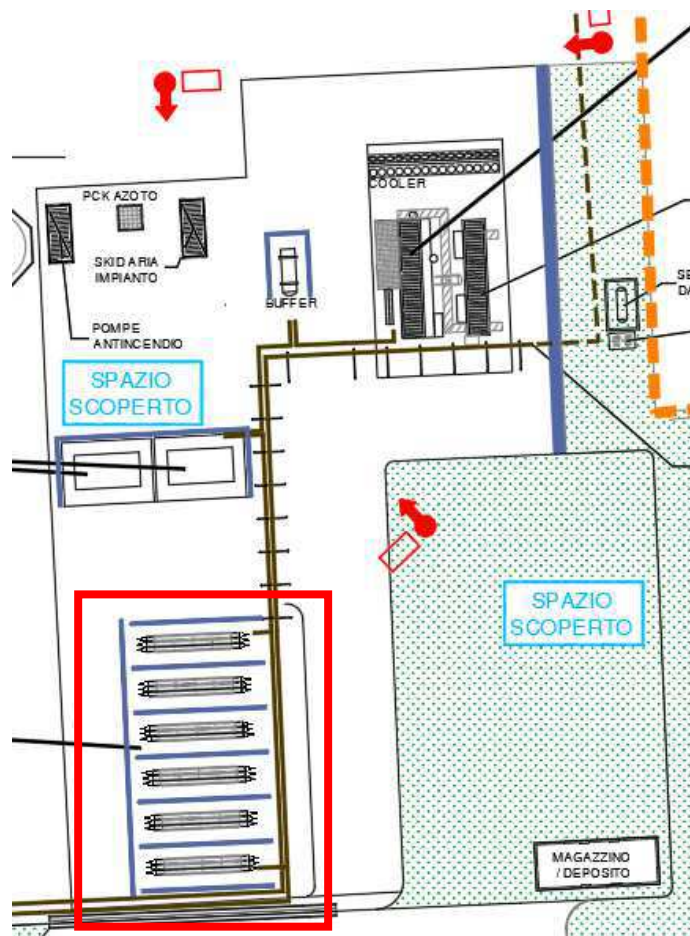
Individuazione planimetrica delle unità di stoccaggio nel Lotto 1
